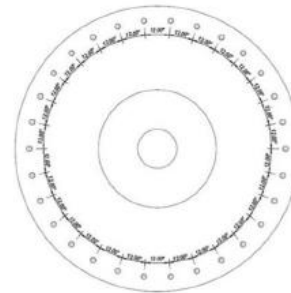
Andamento geometrico della fondazione (pianta – non in scala).
